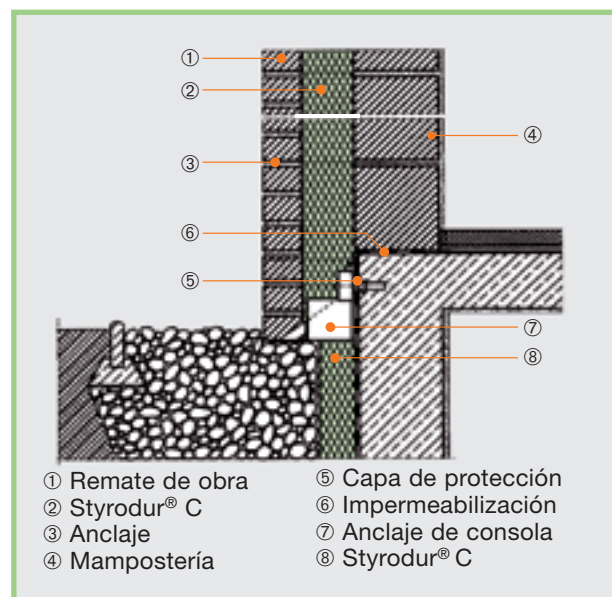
Conexión del aislamiento perimetral en trabajos de mampostería con aislamiento central con anclaje de consola.
